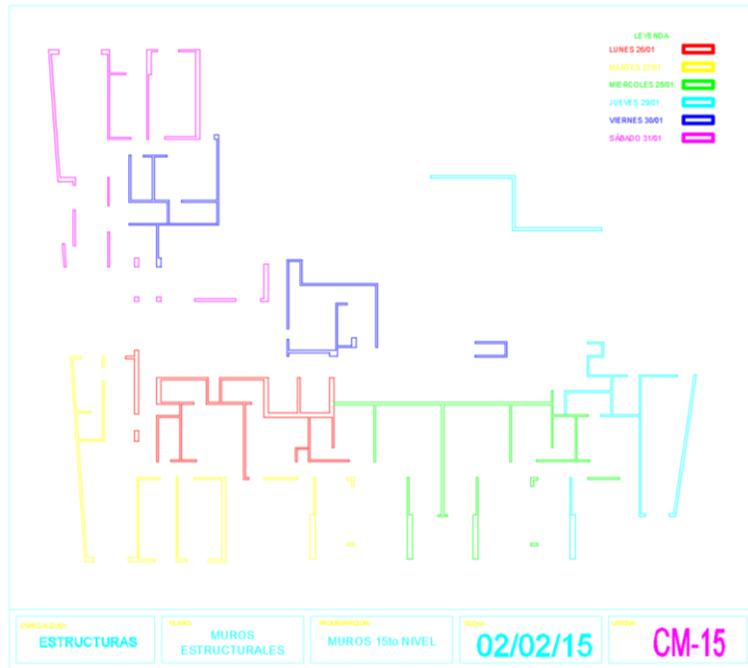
Sectorización de Muros Nivel 15. Fuente: Elaboración Propia
